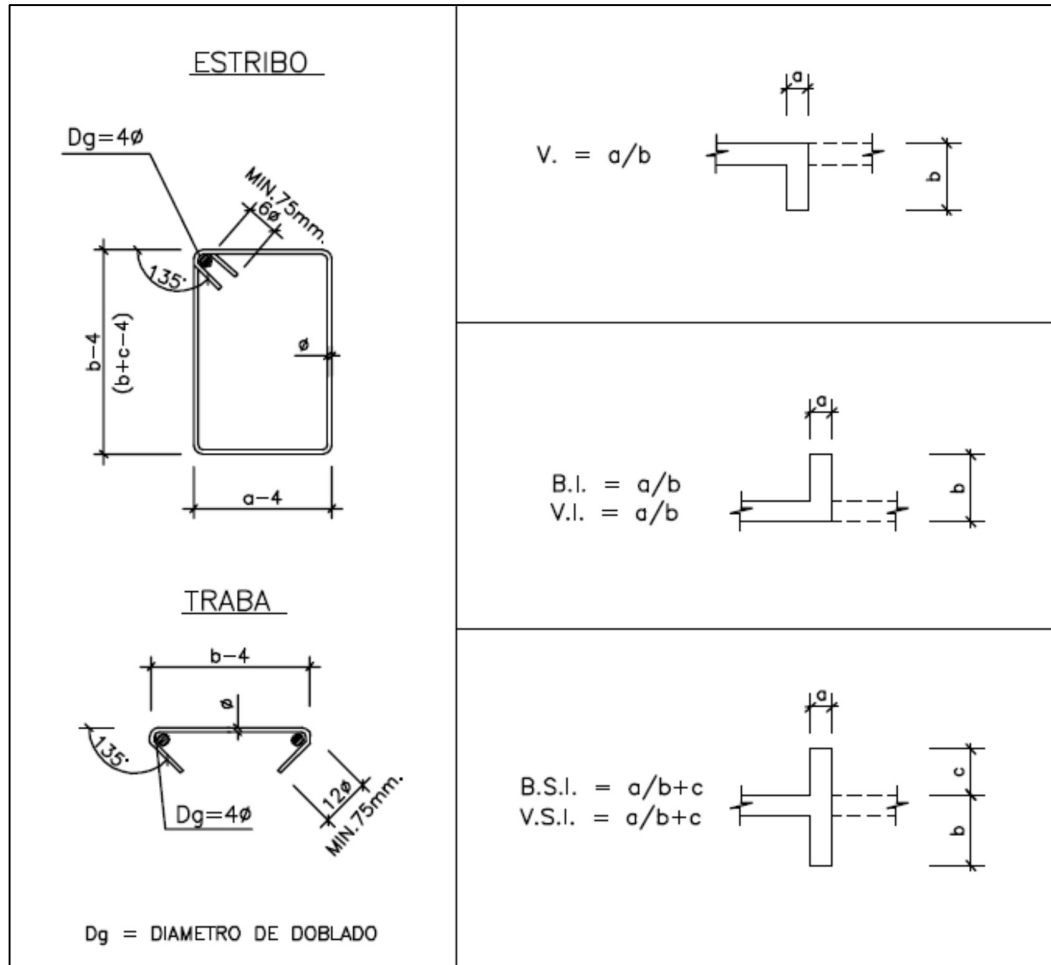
ESTRIBO Y TRABA EN VIGAS Y BORDES.
